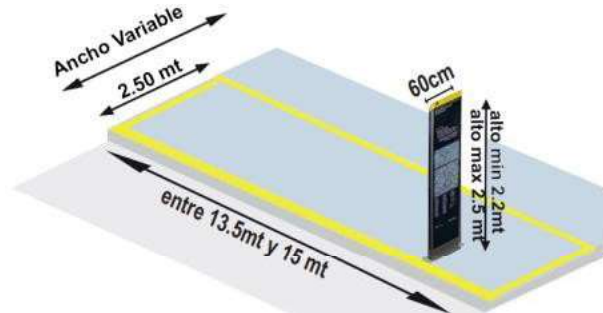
Paradero tipo 1 (Paradero con módulo) Fuente: [6] DADEP
